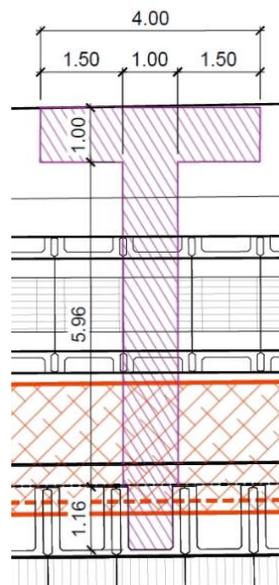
Stralcio planimetrico di uno dei contrafforti.
